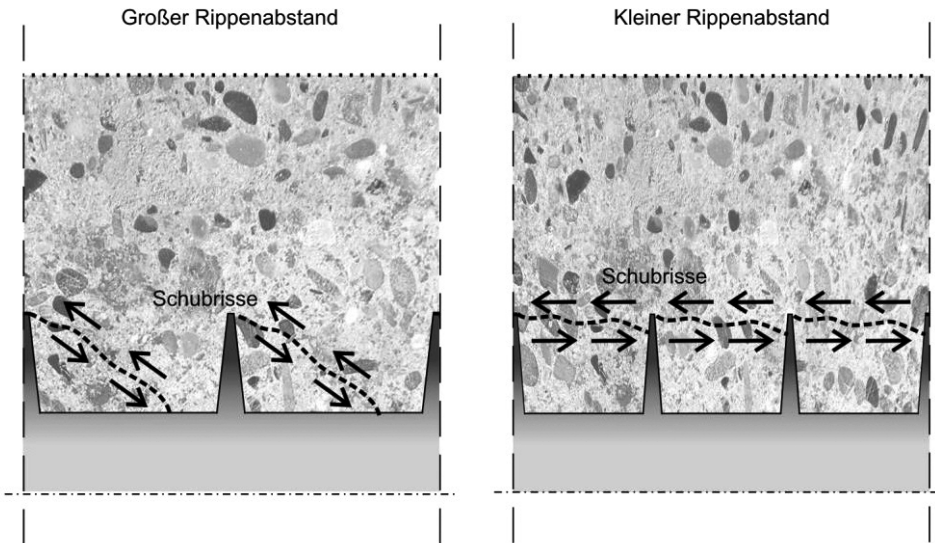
Abscheren der Betonkonsolen (Schubrisse) zwischen den Rippen des Bewehrungsstabes nach Rehm [162]
